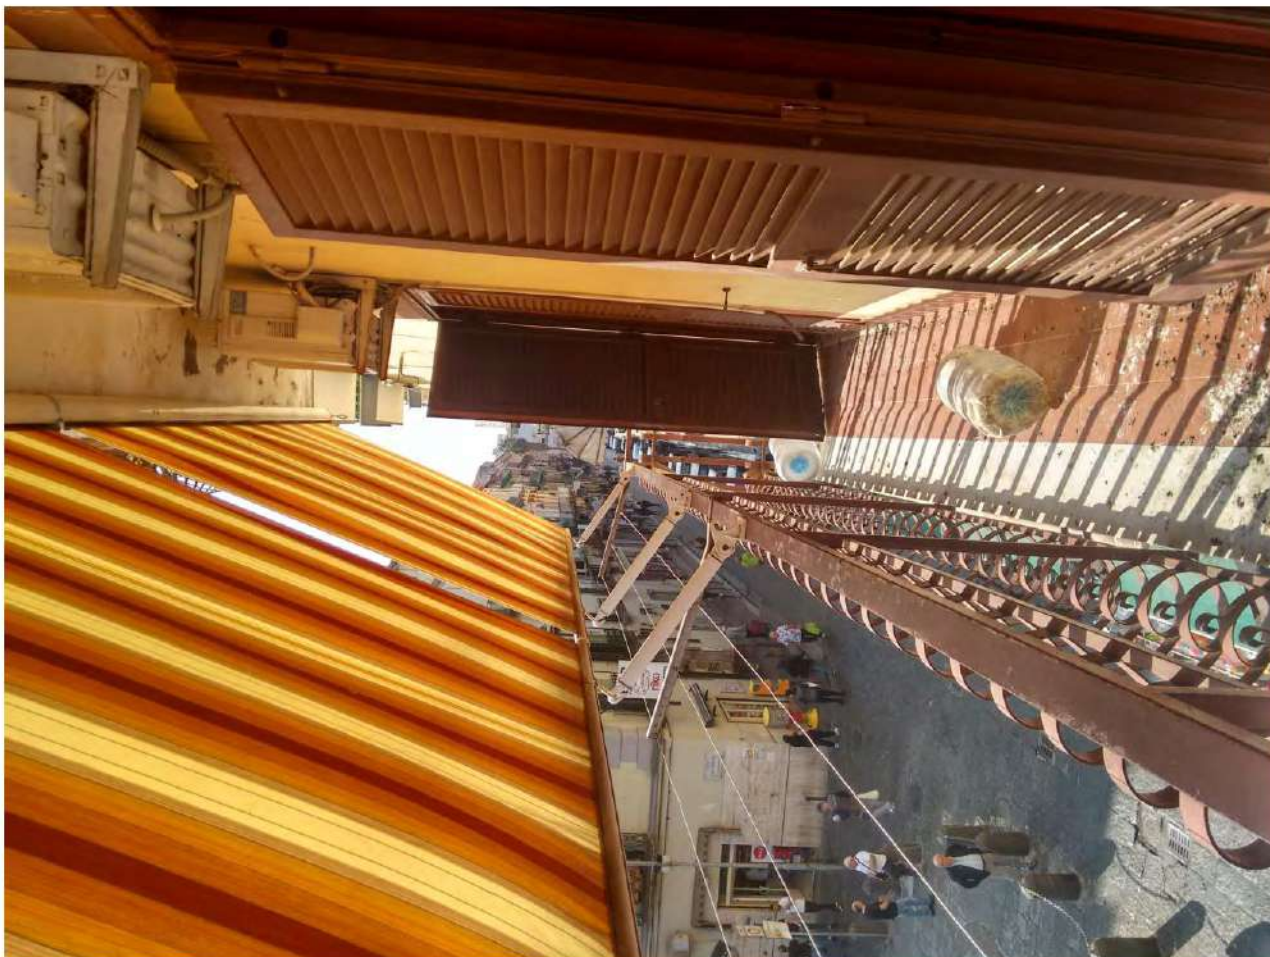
Balcone dell'appartamento ubicato al piano secondo int.3 (sub.108) con affaccio su Via Vittorio Emanuele III
